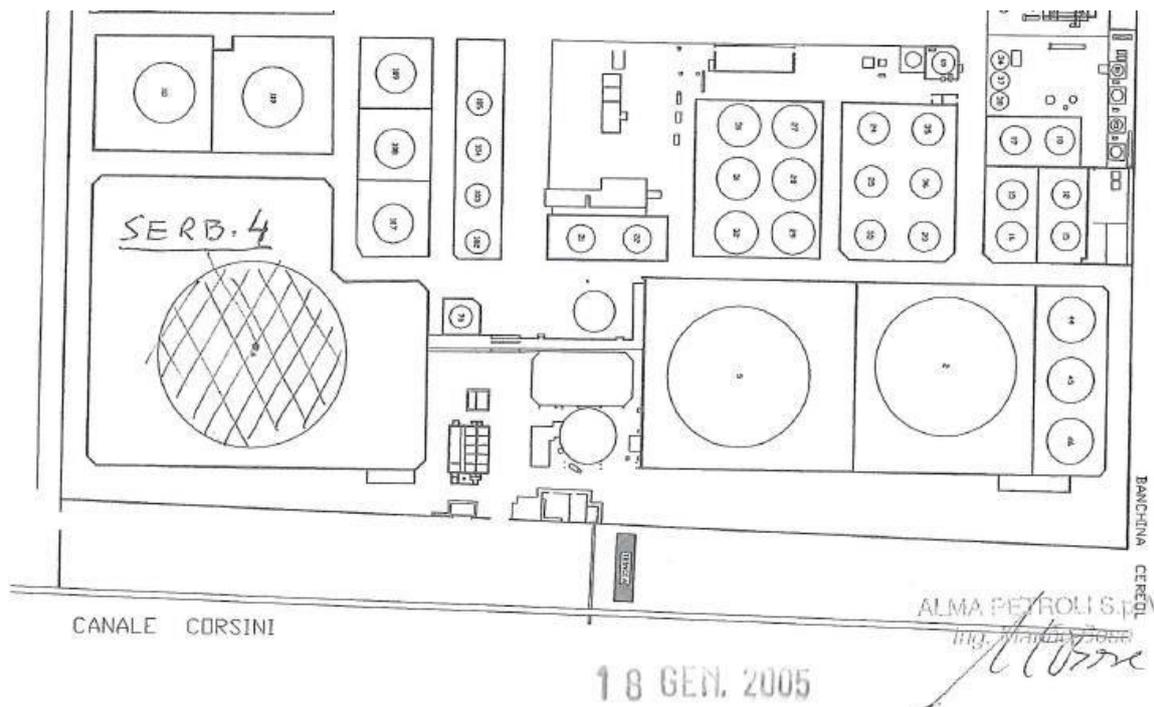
Ortofoto – Planimetria della raffineria con indicazione dei serbatoi più vicini alla banchina
